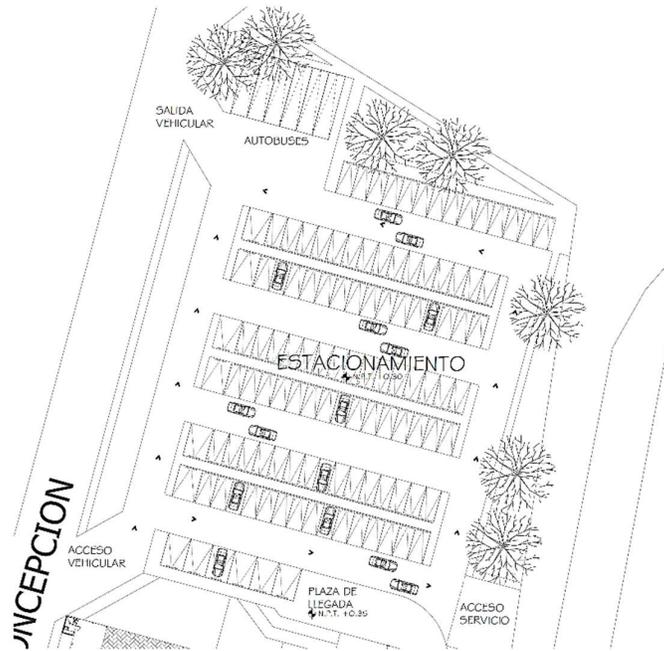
Propuesta de estacionamiento del Complejo de Rehabilitación, Fuente; Plano ARQ-01, propuesta arquitectónica.
